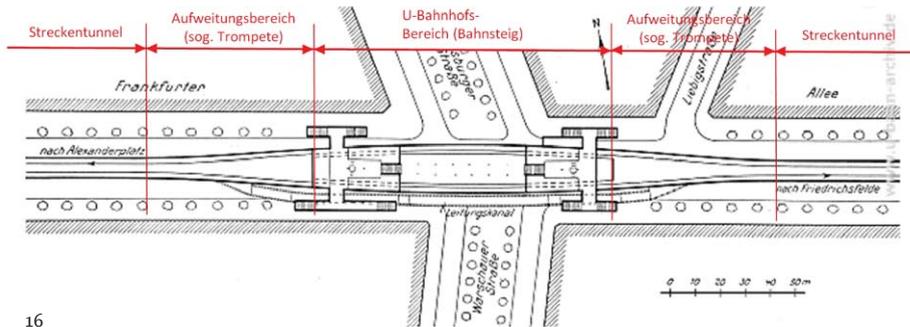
Lageplan eines U-Bahn-Abschnitts mit verschiedenen Tunnelbereichen: Streckentunnel, „Trompete“, Bahnsteig. Plangrundlage: www.u-bahn-archiv.de
